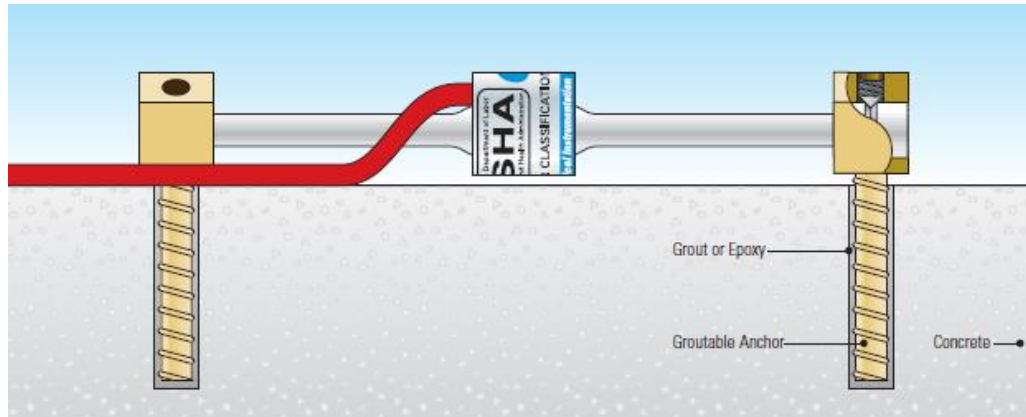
Sensor de cuerda vibrante instalado sobre concreto (Geokon, 2010)
